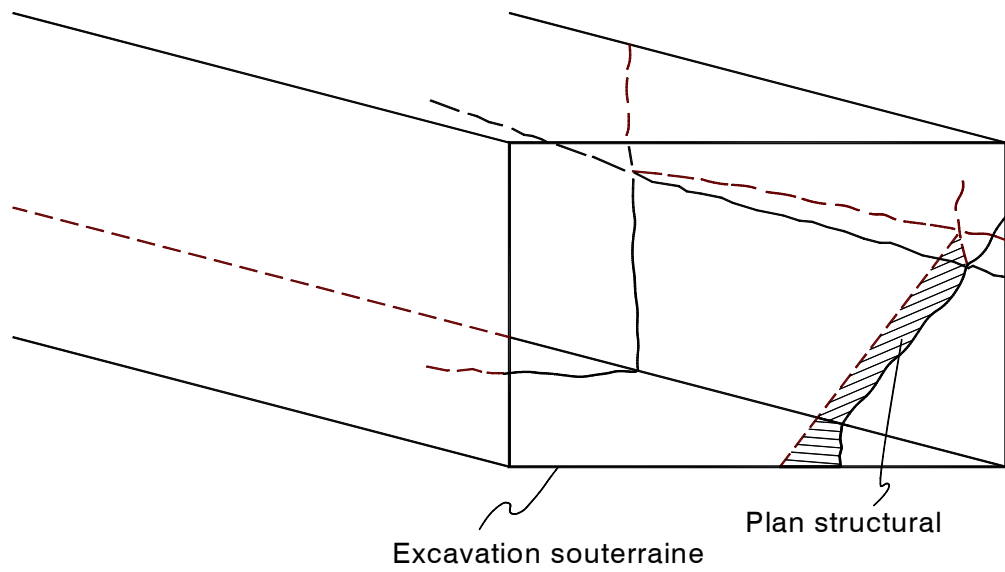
Tétraèdre partiellement exposé, formé par trois plans structuraux qui se rencontrent à proximité d'un parement d'une voie horizontale.
